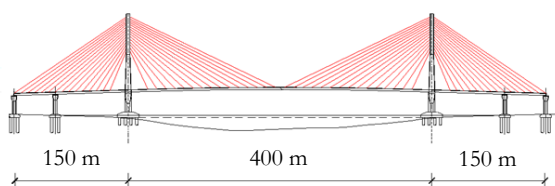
Alzado del puente atirantado sobre el río Dhonogoda.
